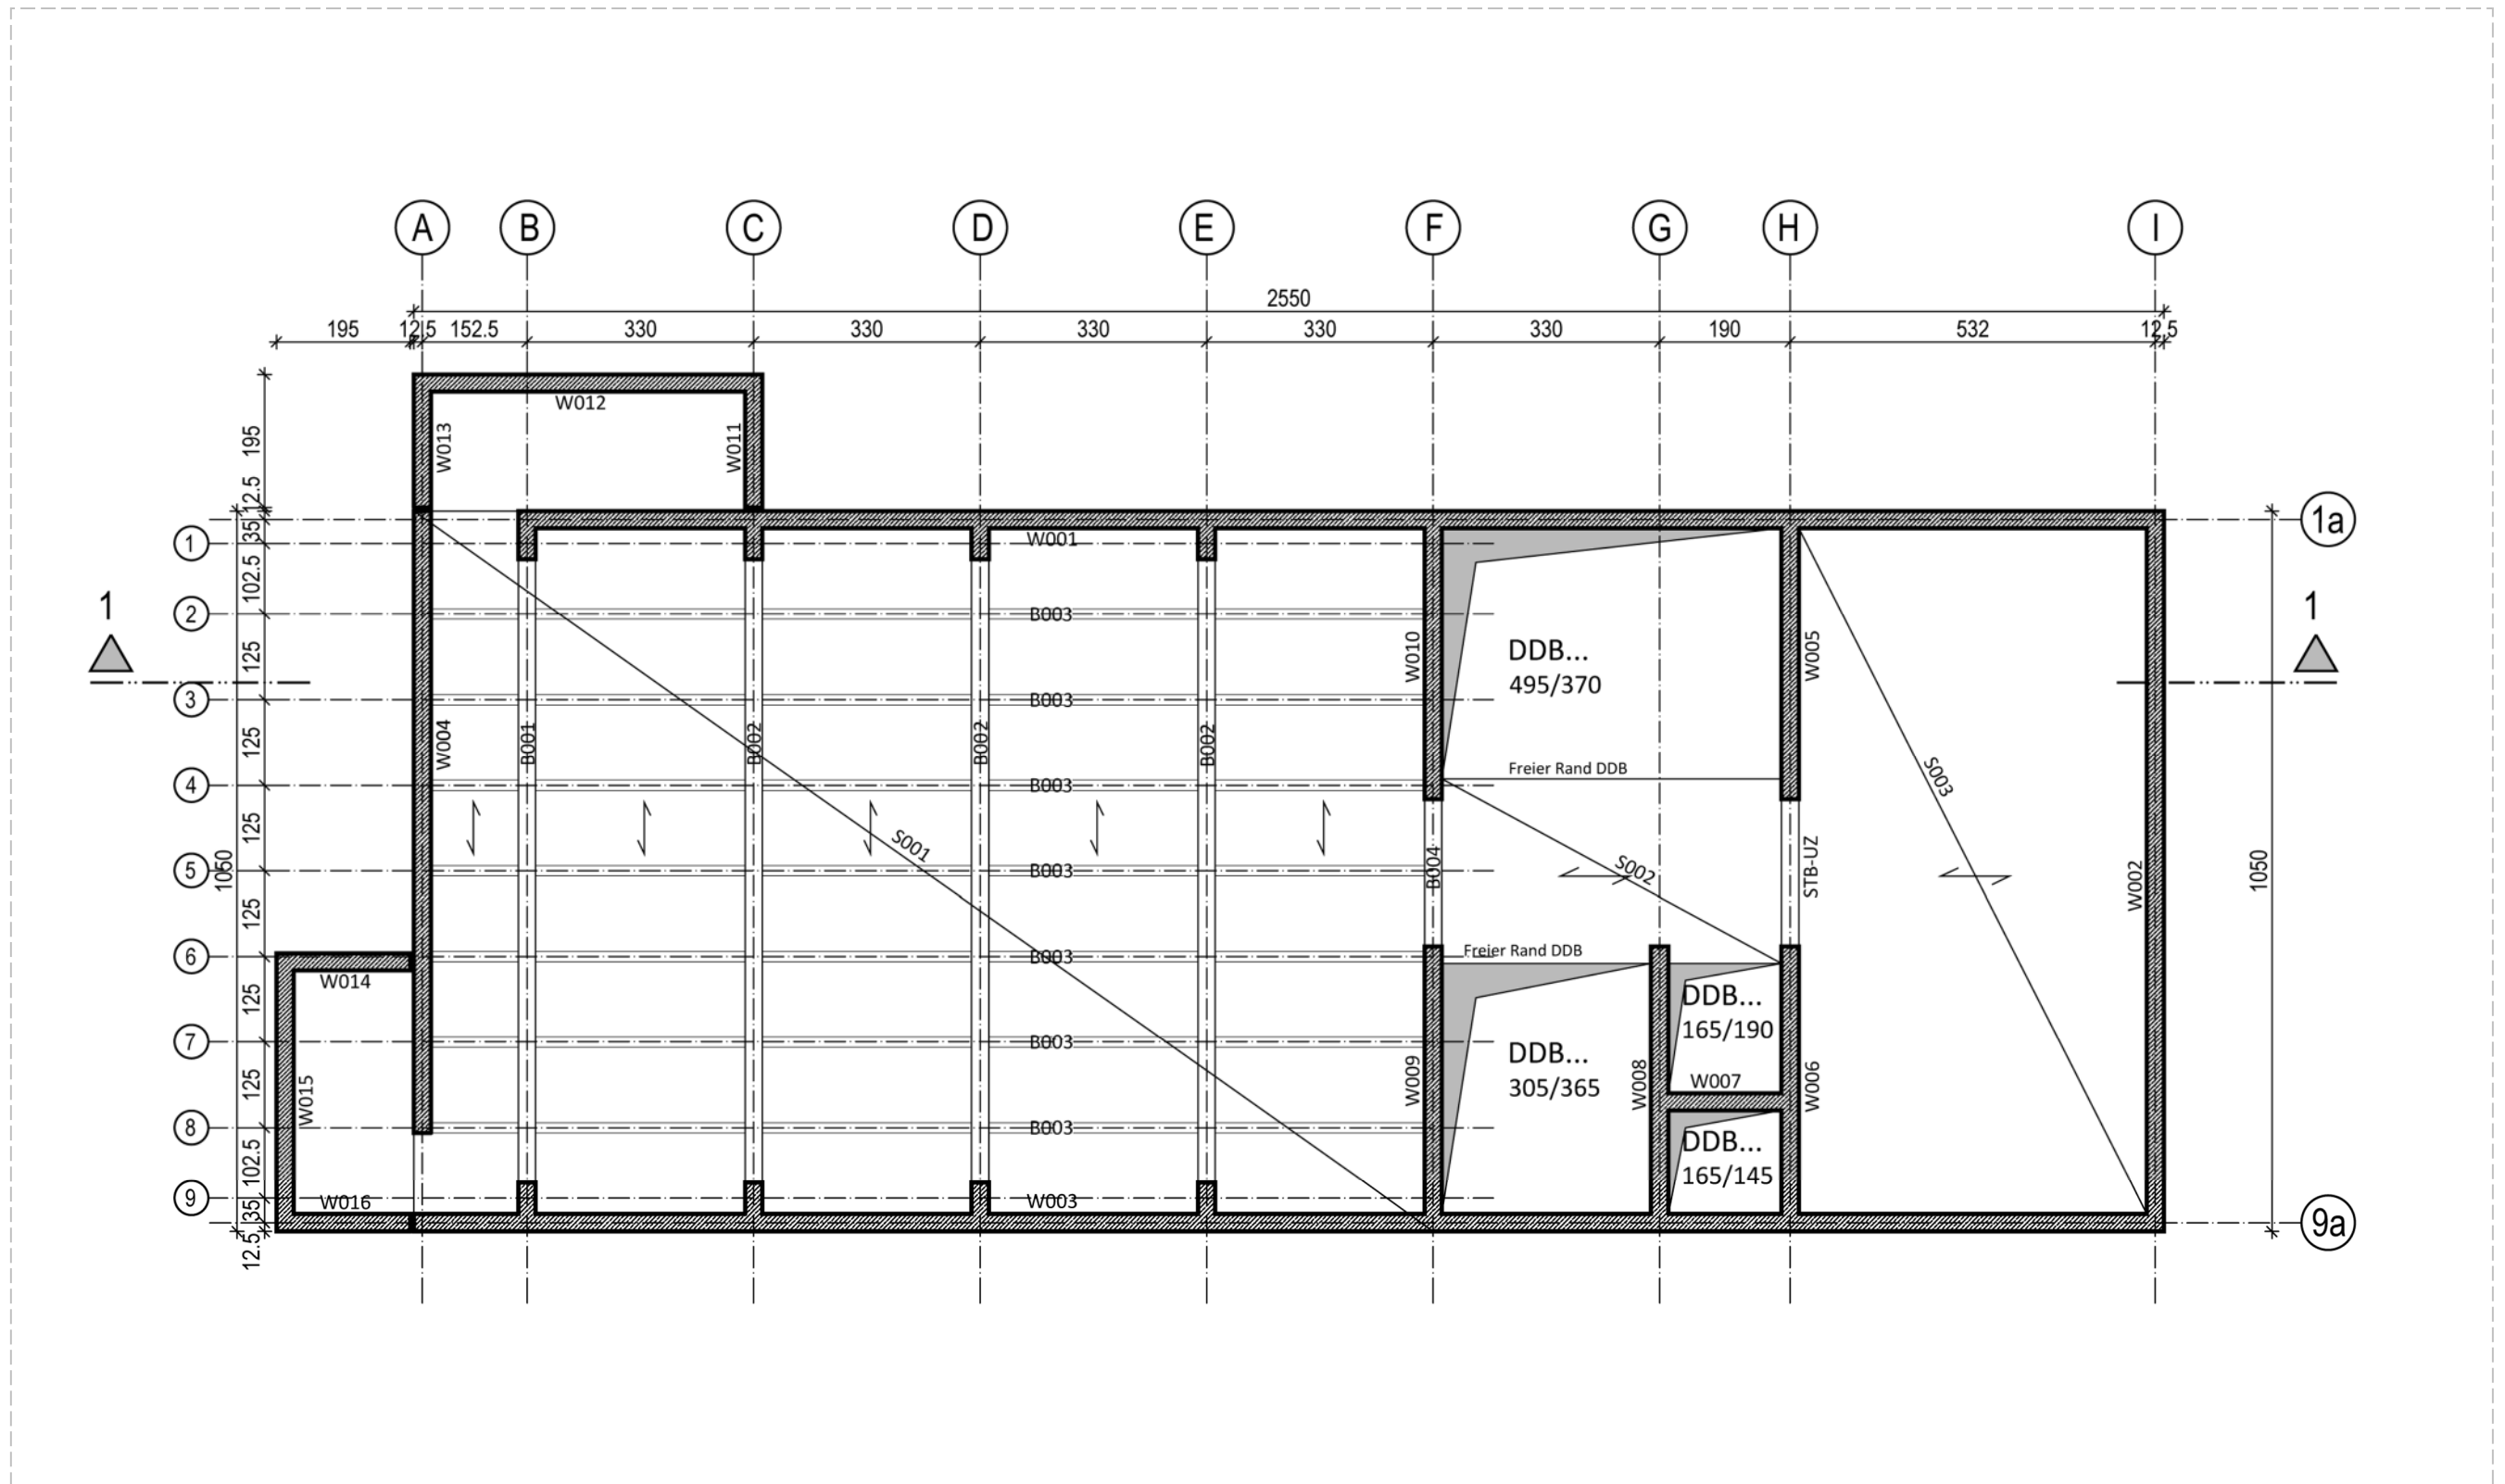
Decke über KELLERGESSCHOSS, M: 1:100 (nur falls Kellergeschoss vorhanden, ansonsten mit Fundament beginnen. Wenn z.B. Plattenfundament, die Platte (nicht schraffiert) darstellen mit Diagonale, bei Streifenfundamenten oder Einzelfundamenten durch die Fundamente schneiden, also schraffieren).
